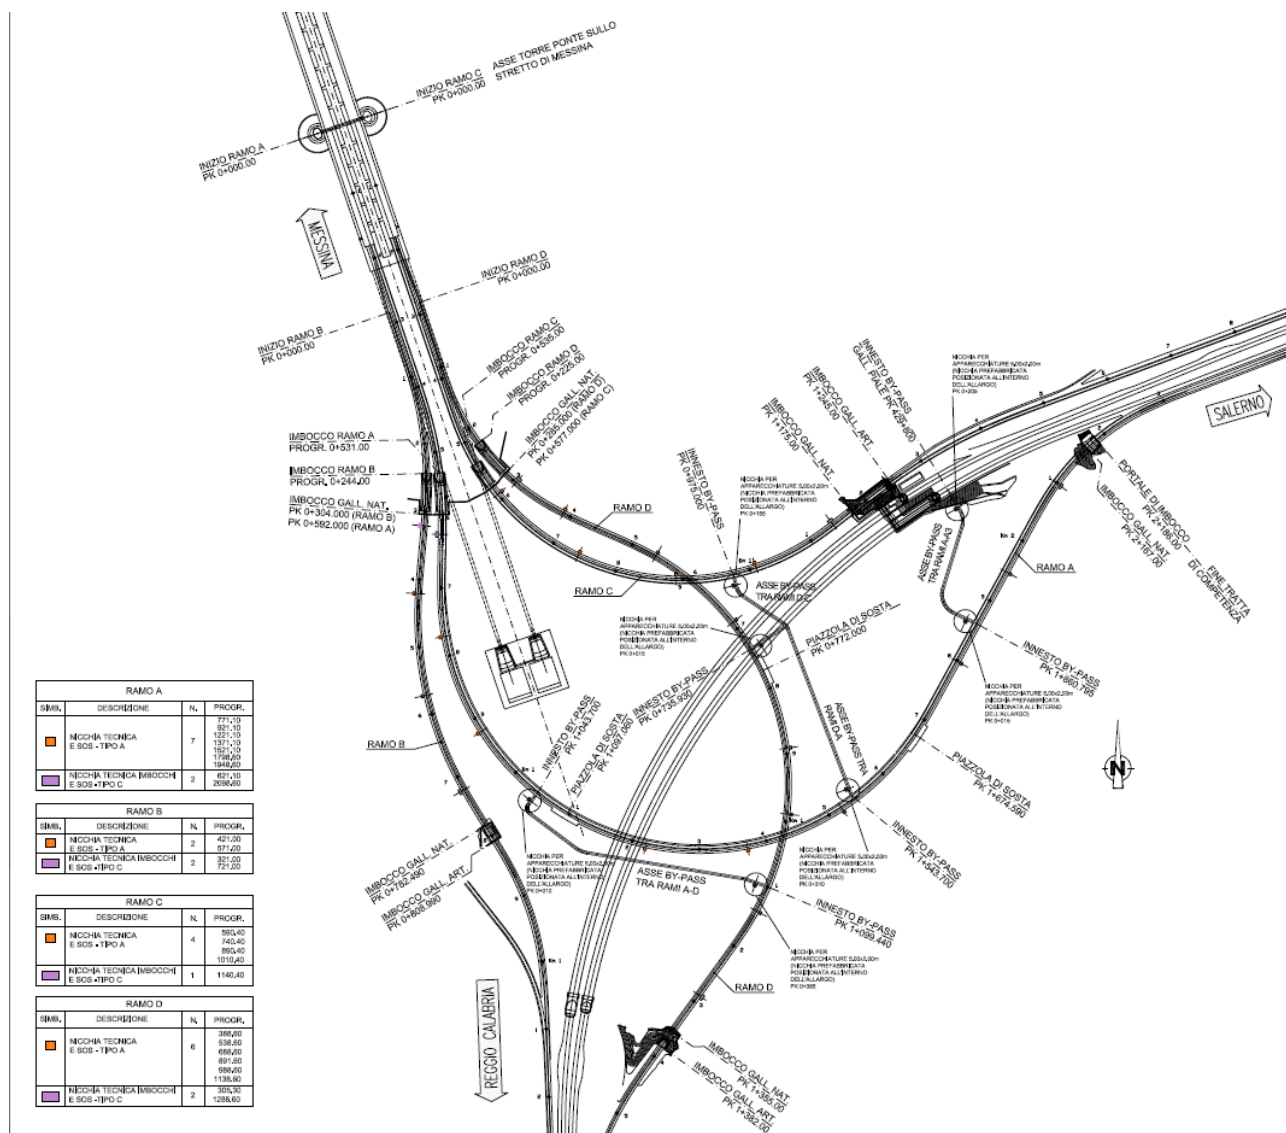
Schema planimetrico delle gallerie stradali
